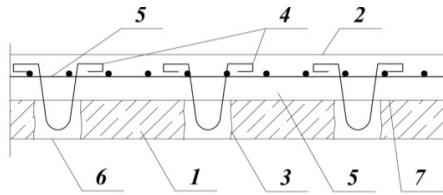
Нарращивание монолитного слоя сверху с устройством железобетонных шпонок [1]:
